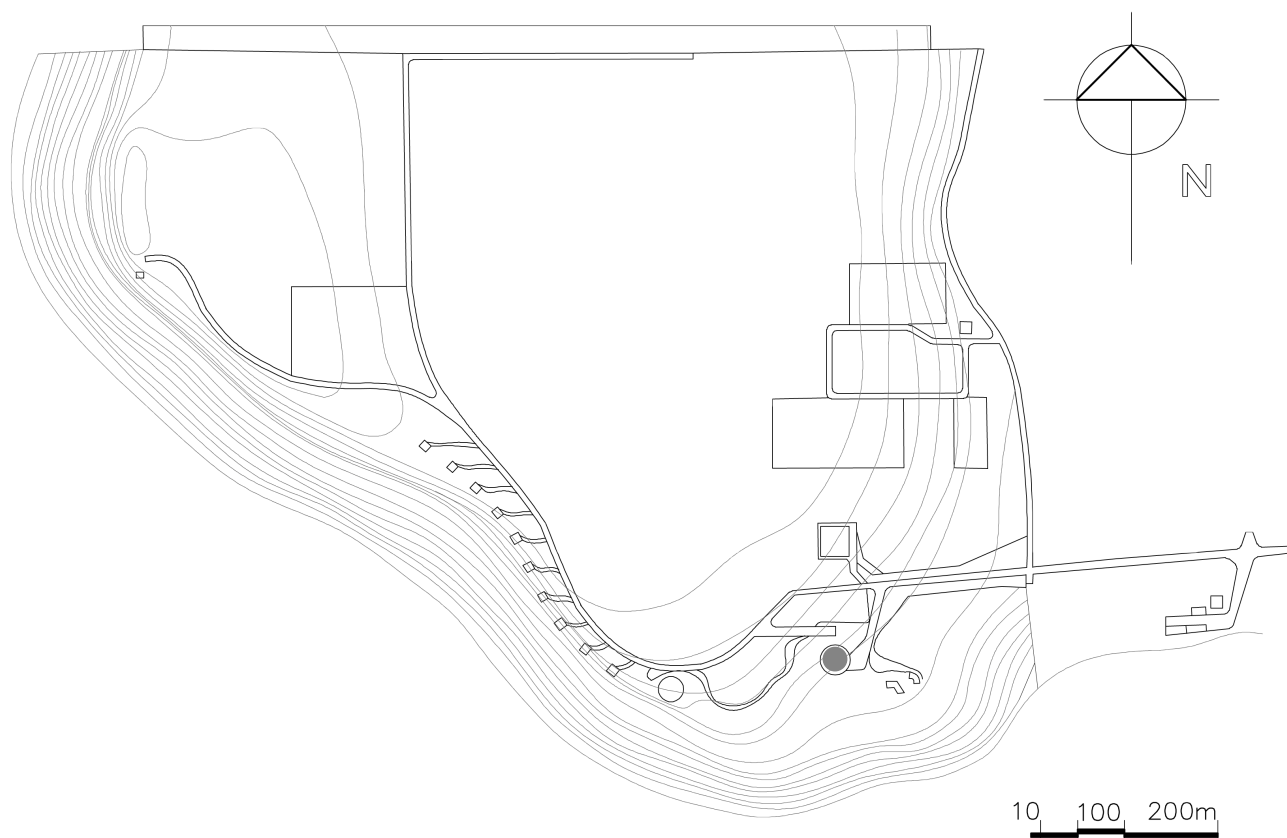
Pousada da Ilha de Silves. Implantação, 2016.
